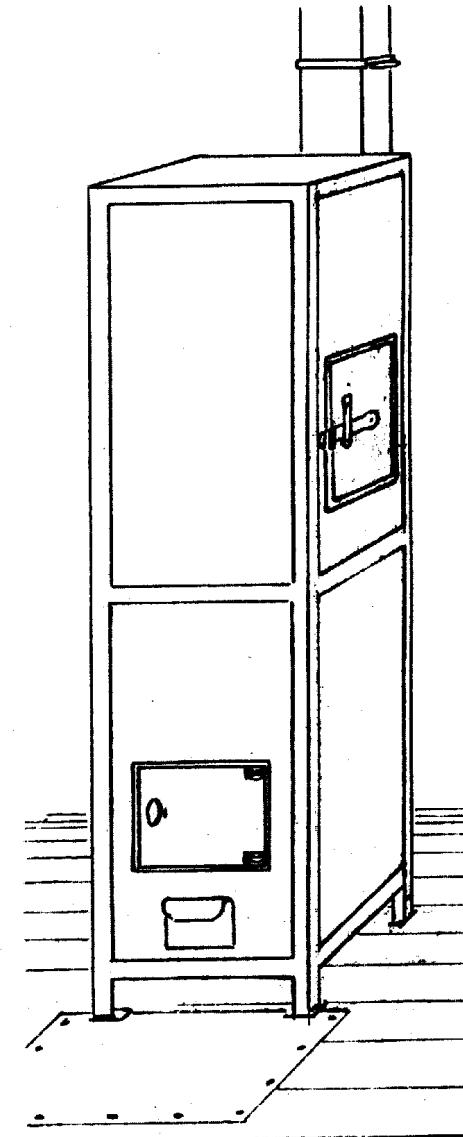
Каркасная отопительно-варочная печь с боковым расположением варочной камеры
